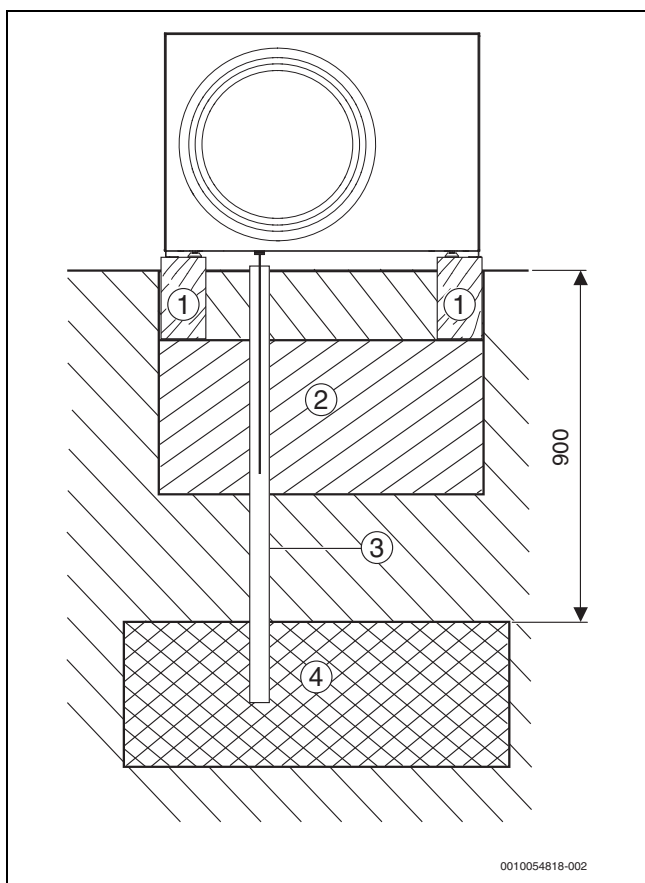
Kondensatableitung in Kiesbett (Abmessungen in mm)
